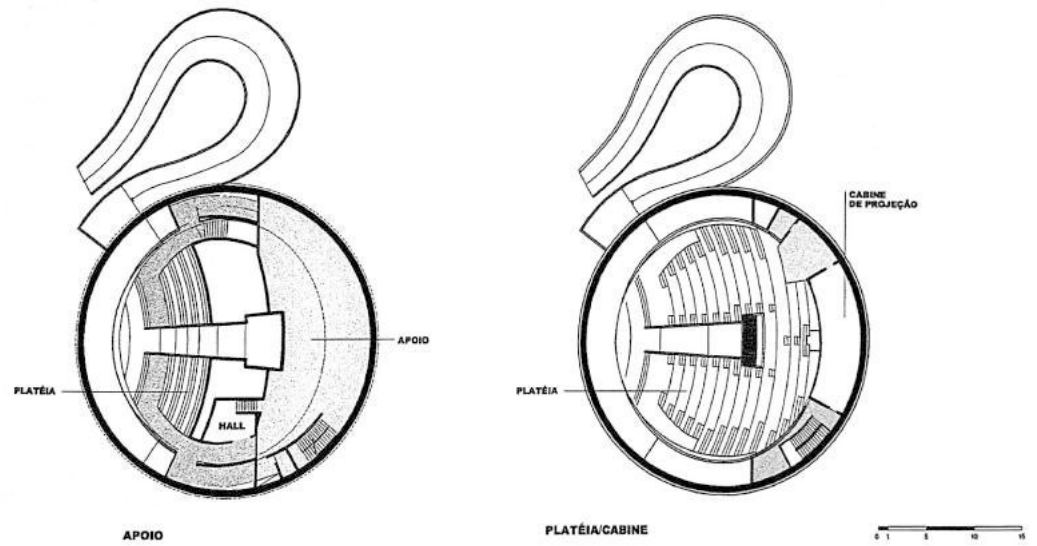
Planta da área de apoio e planta da plateia/cabine, cinema 180 graus, 1999. Fonte: NIEMEYER, 2004.
